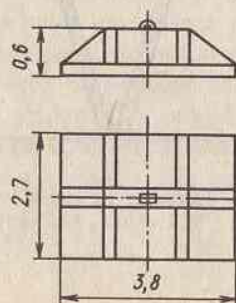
Железобетонная анкерная плита для крепления растяжек опор
